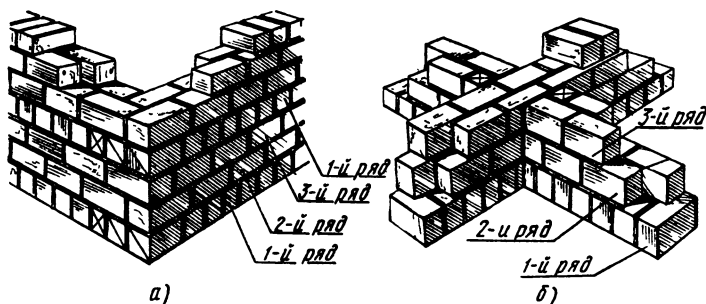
Двухрядная перевязка кладки из бетонных камней: а — угол кладки, б — пересечение стен
